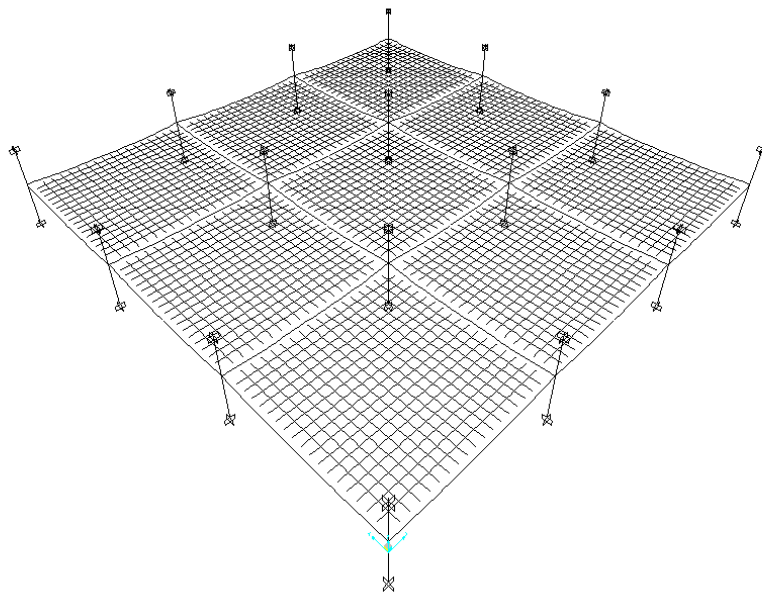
Vista em perspectiva da laje em concreto protendido com cabos de protensão e nervuras
